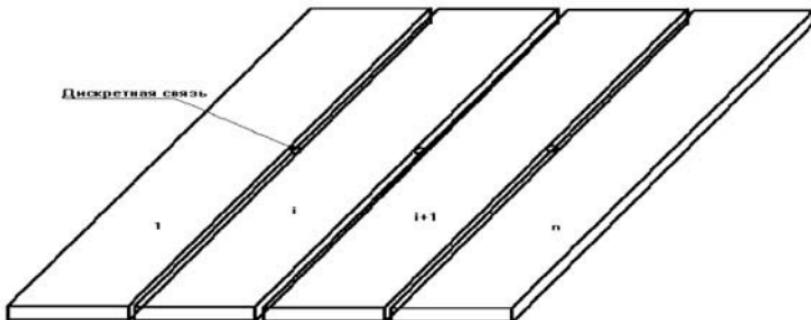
Схема сборного перекрытия с плитами, объединенными дискретными связями в середине пролета
